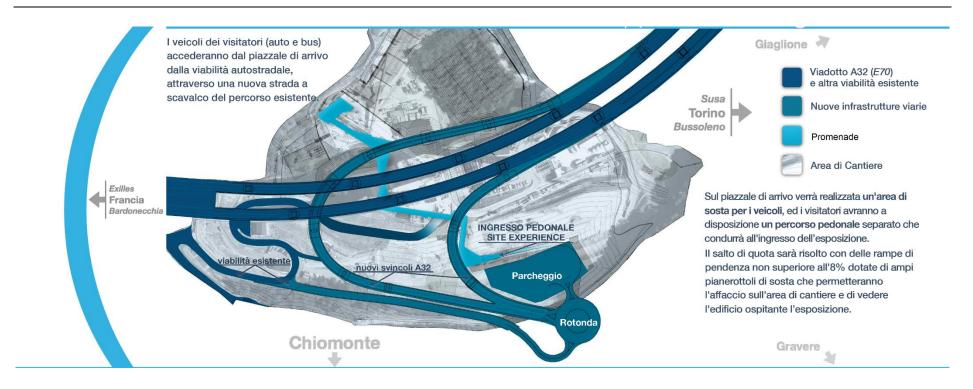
CONCEPT ARCHITETTONICO\_planimetria generale
